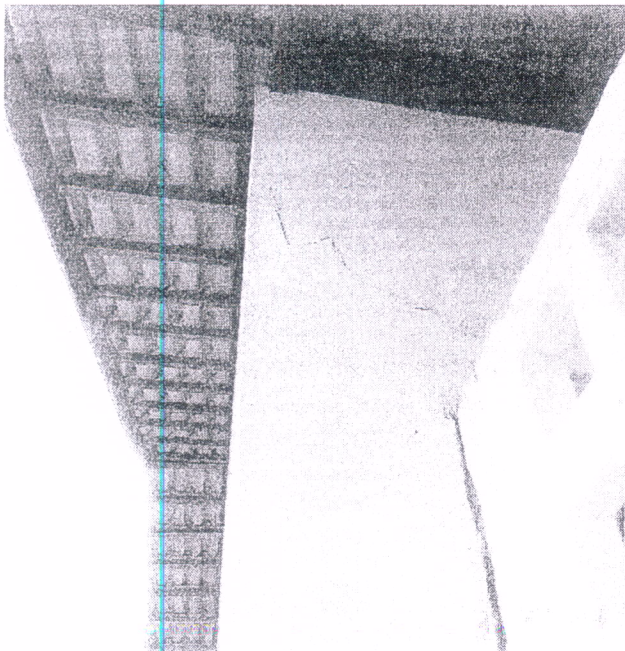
Fissuras inclinadas nas alvenarias dos dormitórios junto à parede de cobogós que fecha a área de jardim.
